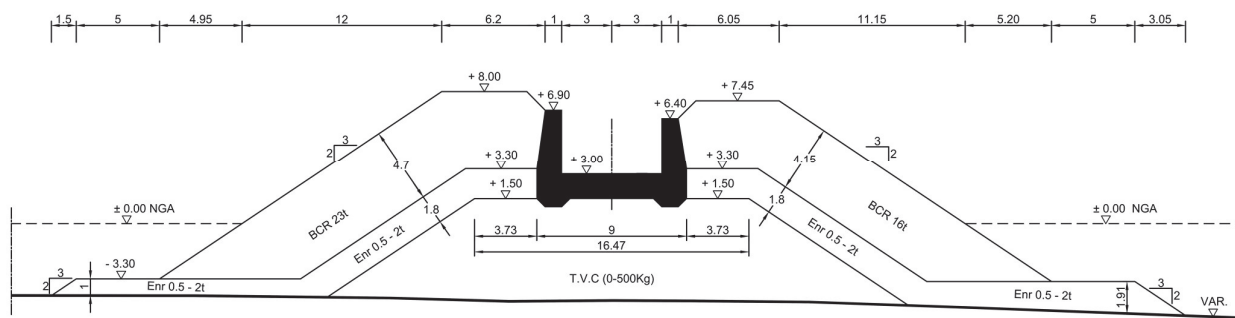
Coupe transversale du profil musoir de la jetée principale
